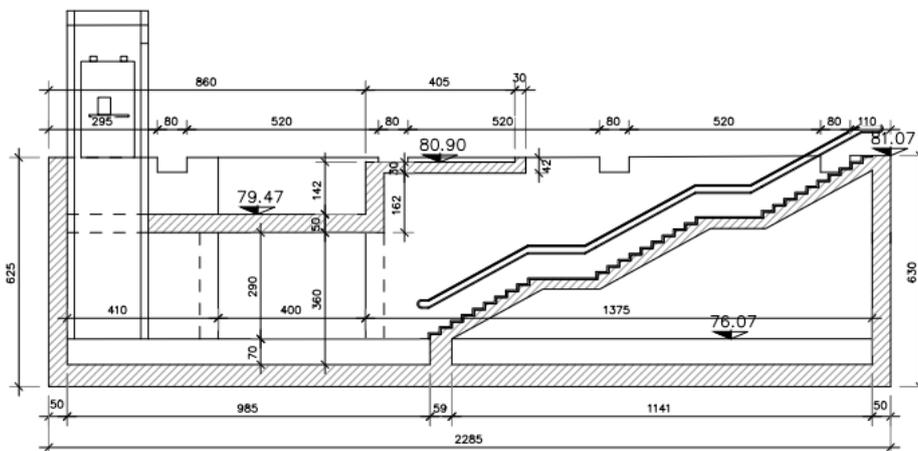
Sezione longitudinale su rampa singola sottopasso
